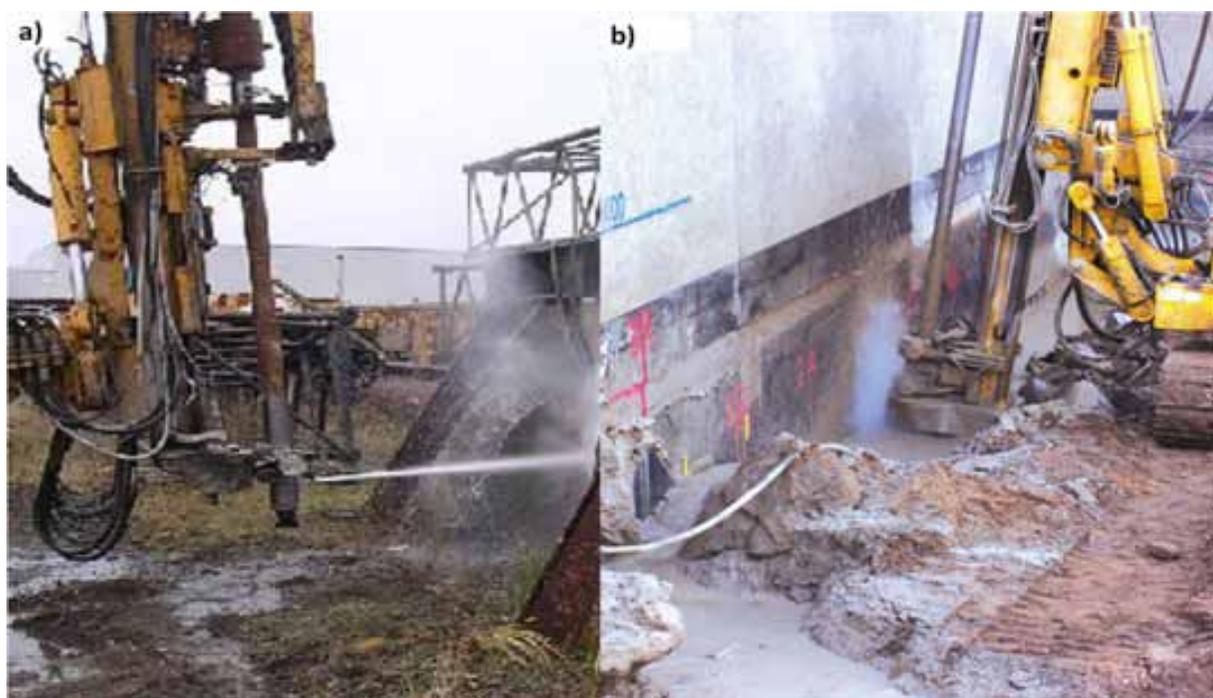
Equipamento utilizado para execução de colunas e painéis em Jet Grouting: a) Jato horizontal de alta pressão; b) Versatilidade para execução de reforços próximos a estruturas existentes (Fonte: Bilfinger Berger Foundations).
